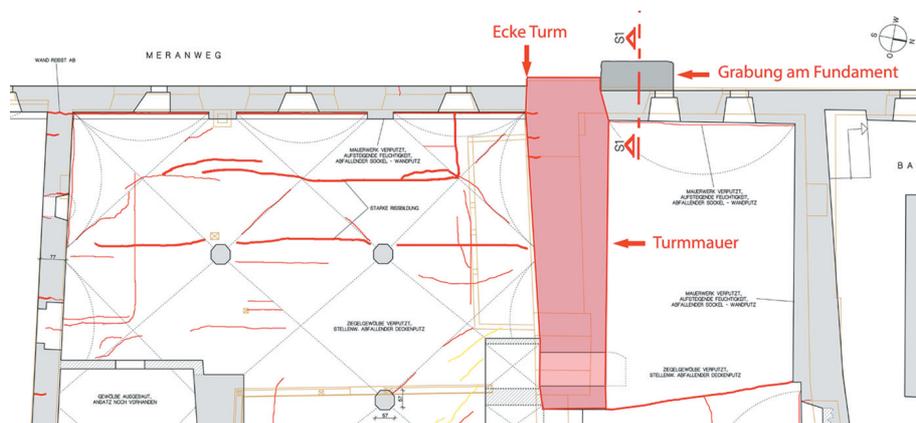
Grundrissdetail des KG's im Bereich des ehemaligen Torturms aus dem Plangutachten der Firma ALS von 2009 (südliche Turmwannd ist rot eingefärbt)
